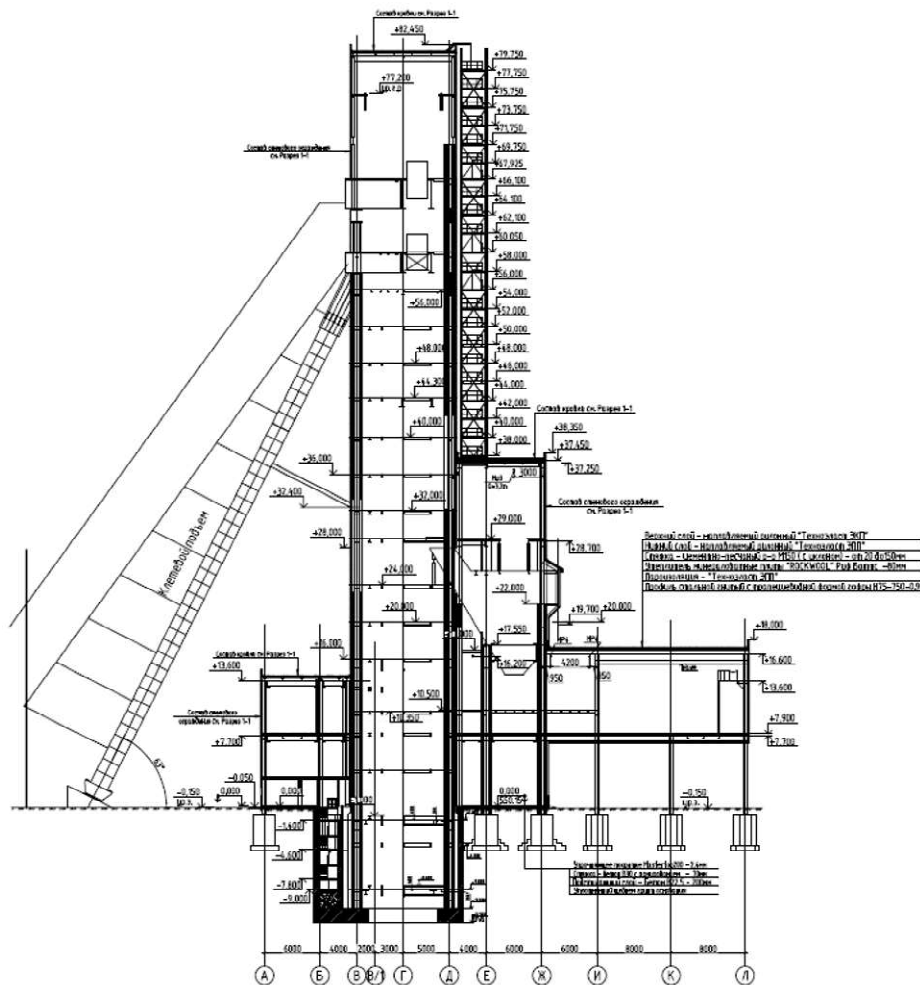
Башенный металлический копер скипо-клетьевого подъема разрез.
